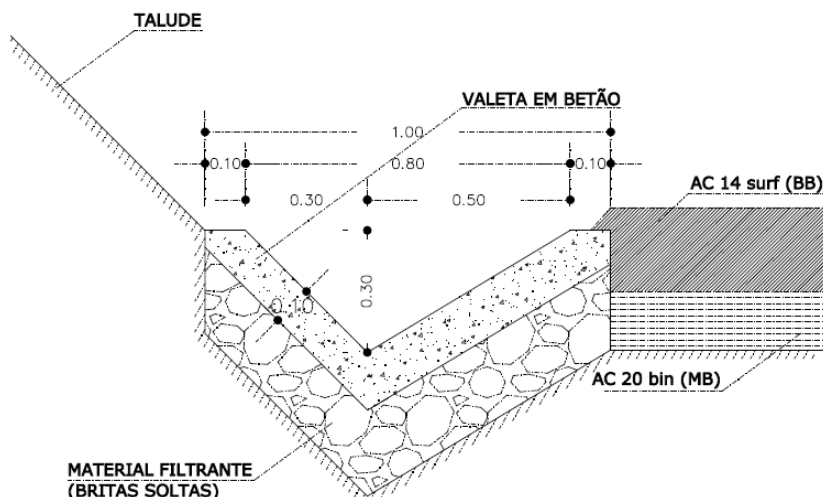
Pormenor valetas de drenagem pluvial (dimensões em metros).
